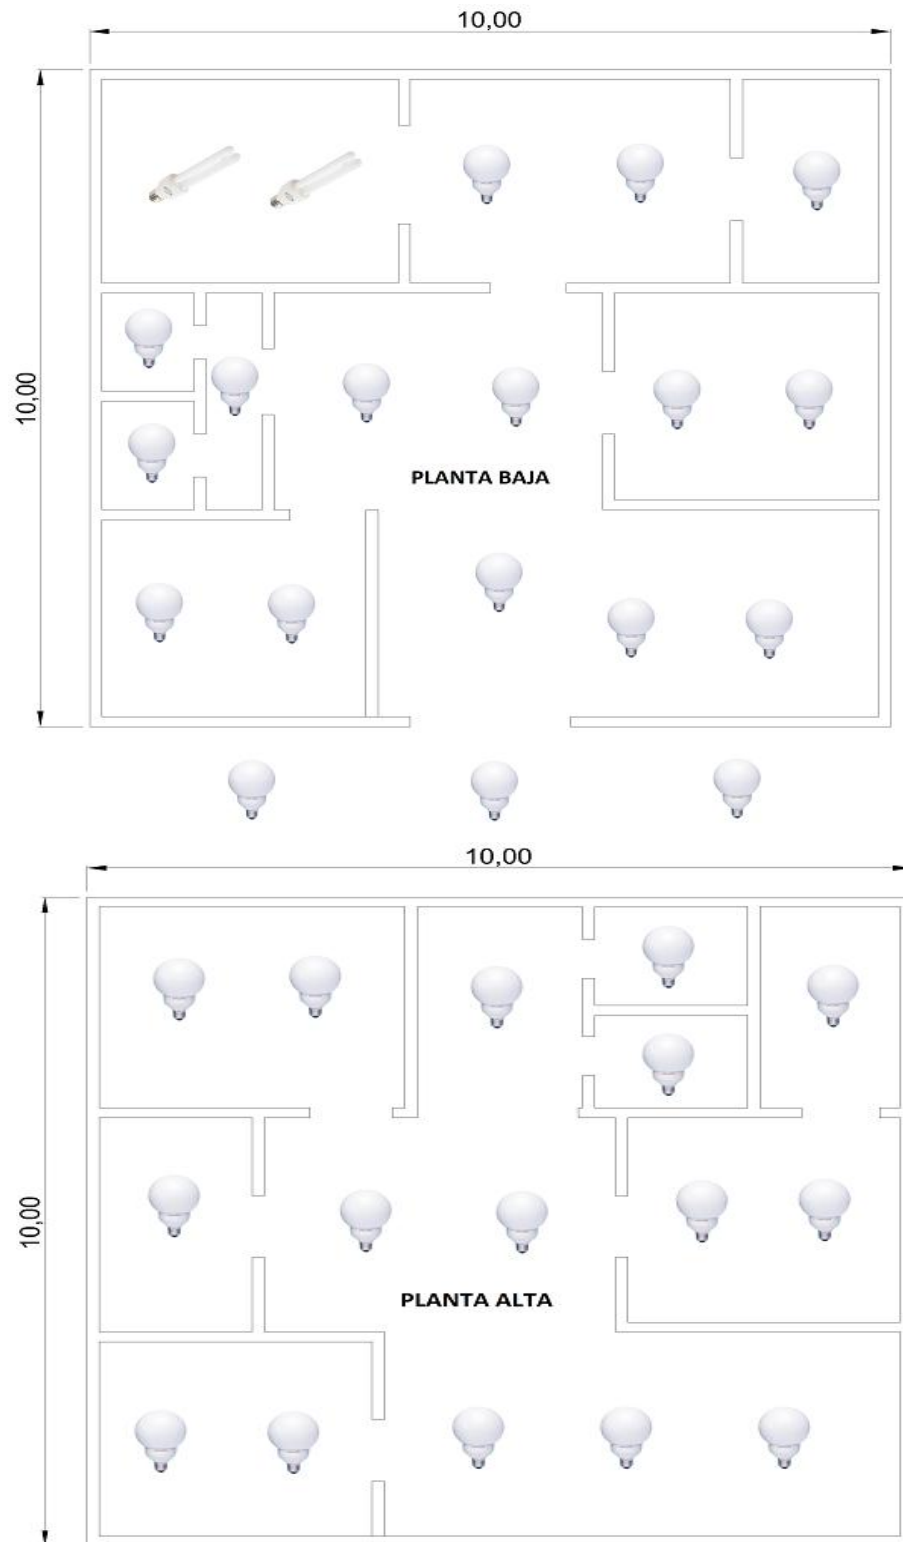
Esquema de distribución de luces Planta alta y baja.
